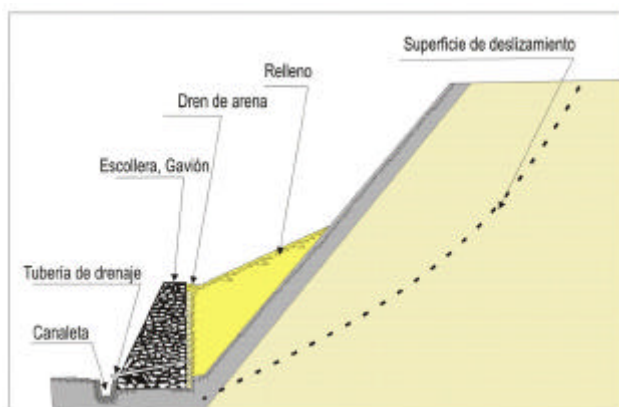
Muro permeable al pie del talud de una zona con deslizamiento.
